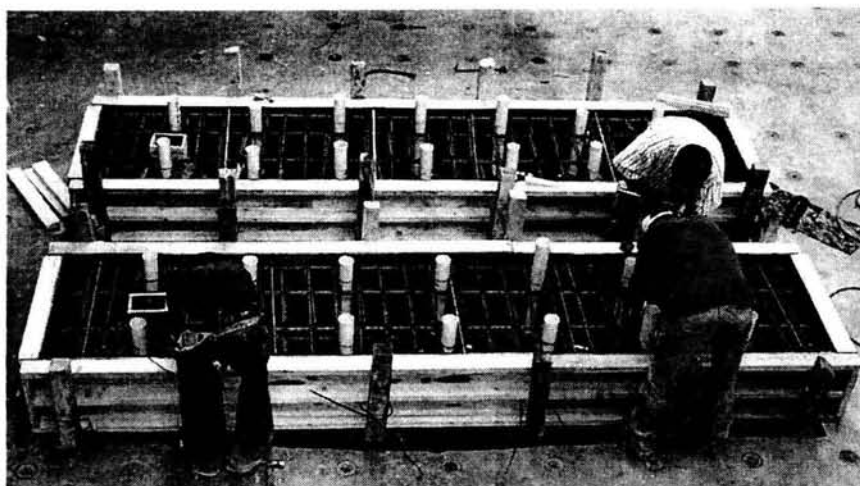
Armado y cimbrado de las vigas de cimentación
